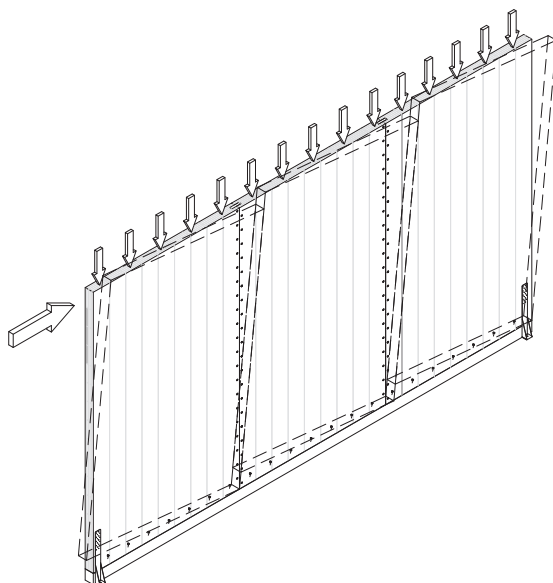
Parete X-Lam soggetta ad azioni orizzontali nel piano. La resistenza a taglio nel piano della parete è data dalla resistenza a taglio dei collegamenti chiodati tra pannelli.
